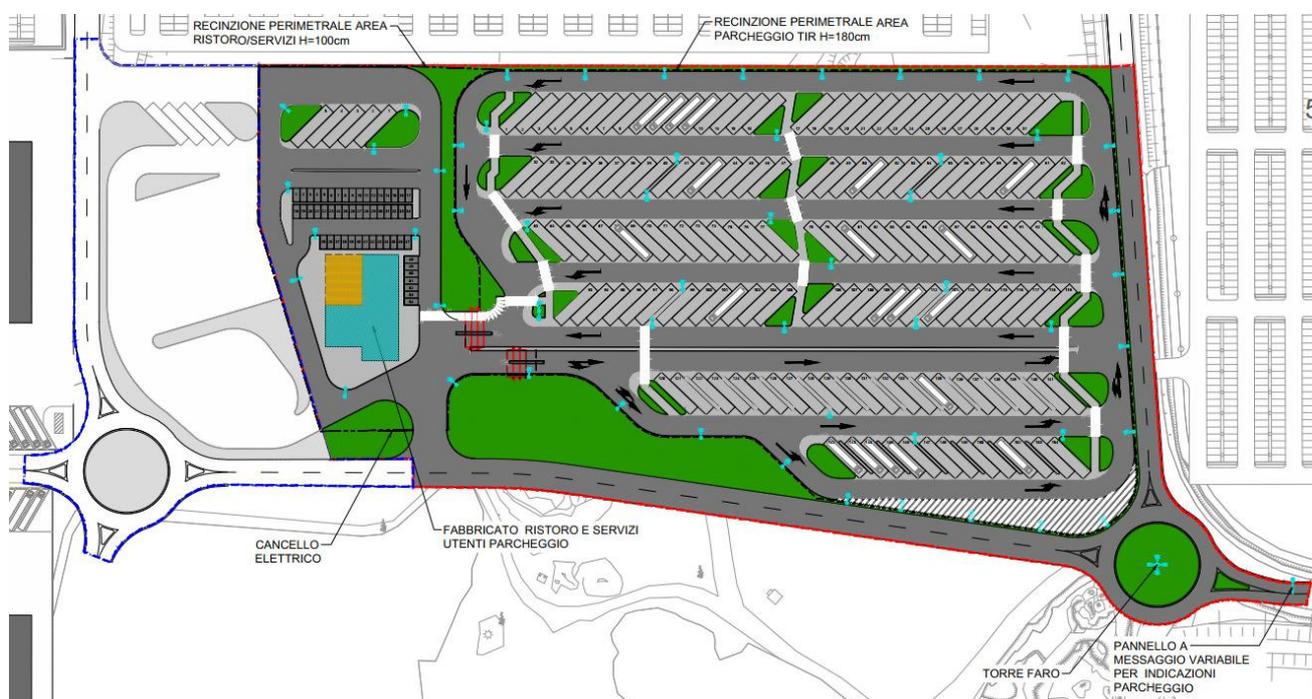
Planimetria generale (vedi elaborato VP002 Planimetria di progetto)
